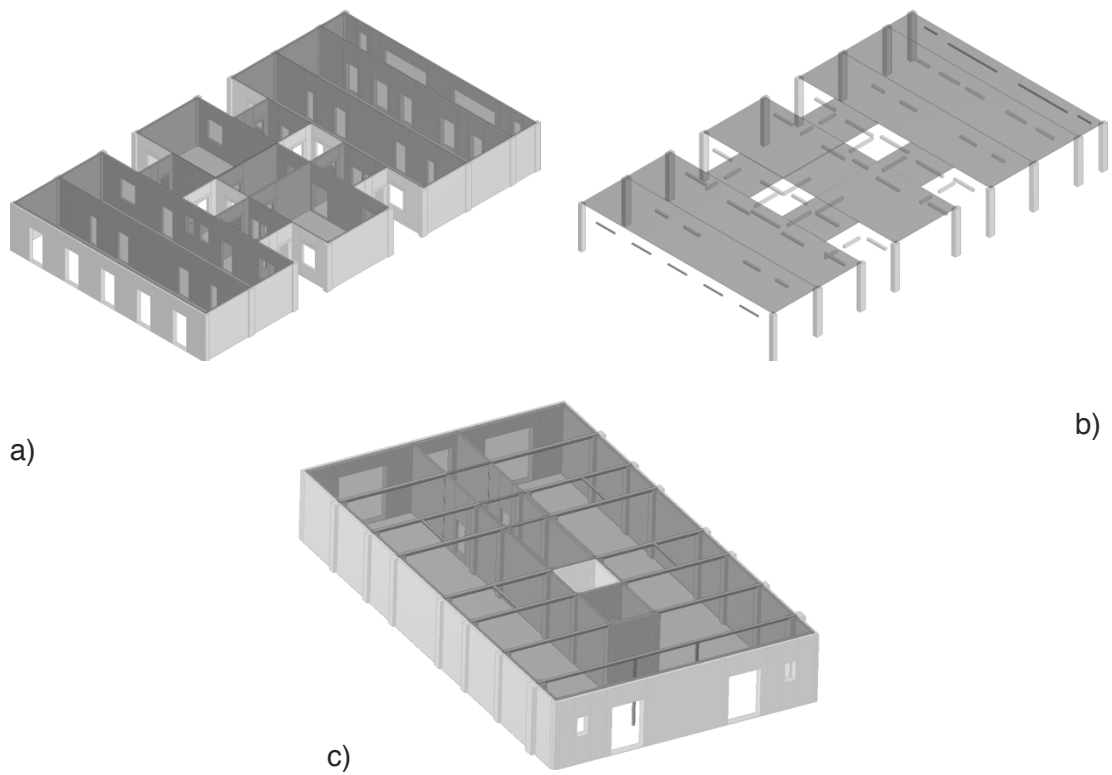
Modelo Tremuri edificio ED-01 planta tipo. a) Vista isométrica fachada principal. b) Vista isométrica fachada principal sin muros. c) Vista isométrica fachada trasera
